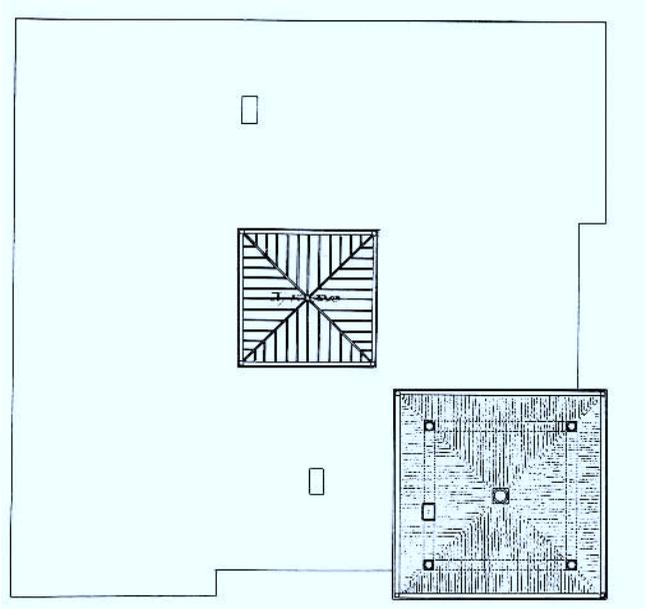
Proyecto para el Ayuntamiento de Carranza realizado en 1924 por el arquitecto Julio Sáenz de Barés. Planta de cubiertas. (Edificio no construido).
